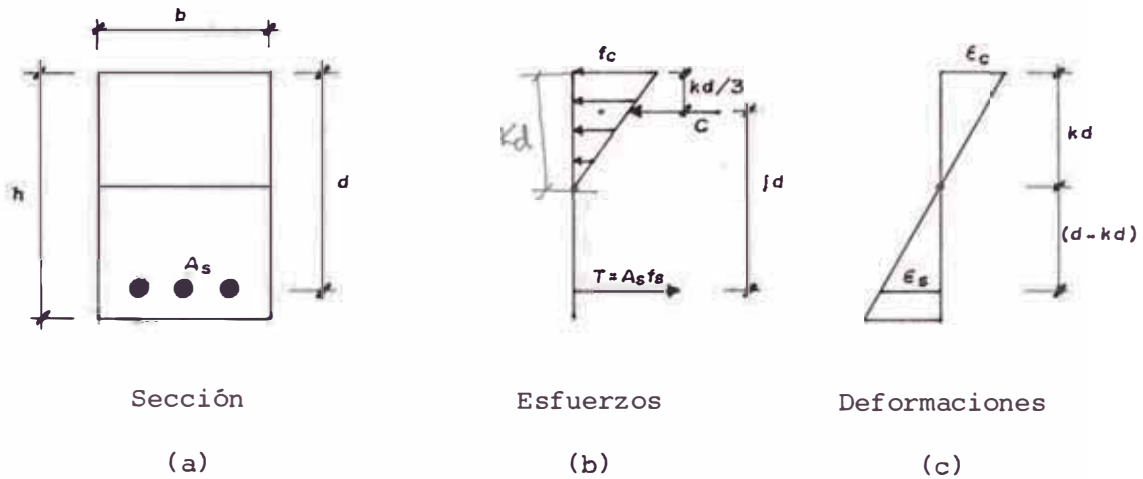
Sección de una viga rectangular en estado elástico agrietado
